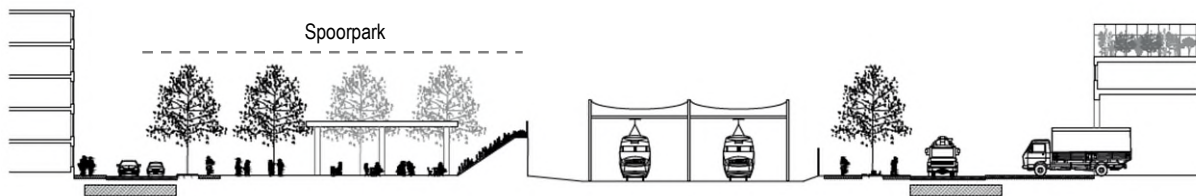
Spoorpark, coupe transversale indicative (Bas Smets, 2016)
